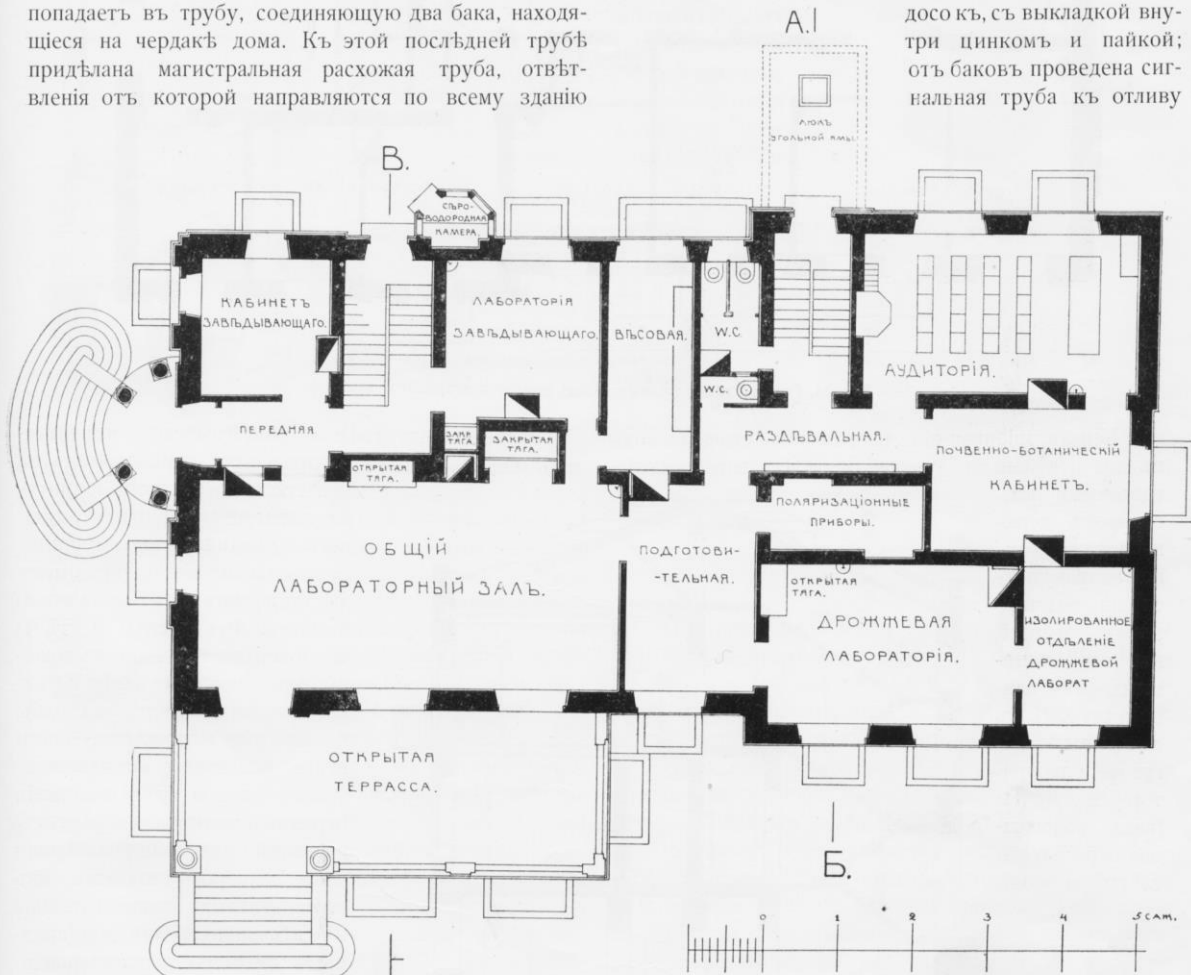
Главное зданіе Станціи. Планъ средняго этажа (съ натуры).
